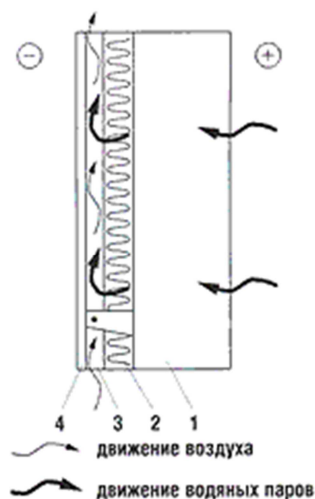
Схема устройства «вентилируемого» фасада: 1 – утепляемая стена; 2 – утеплитель; 3 – вентилируемая воздушная прослойка; 4 – наружная облицовка
